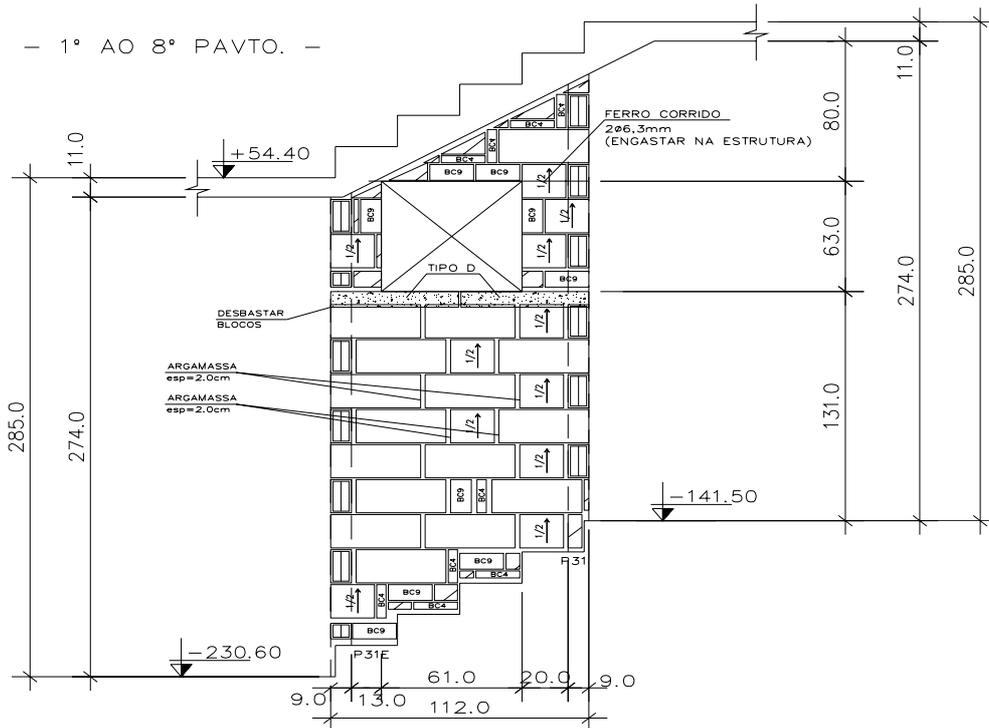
Elevação da parede na região central da escada revisada pelo projeto de vedação para o 1º ao 8º pavimento.
